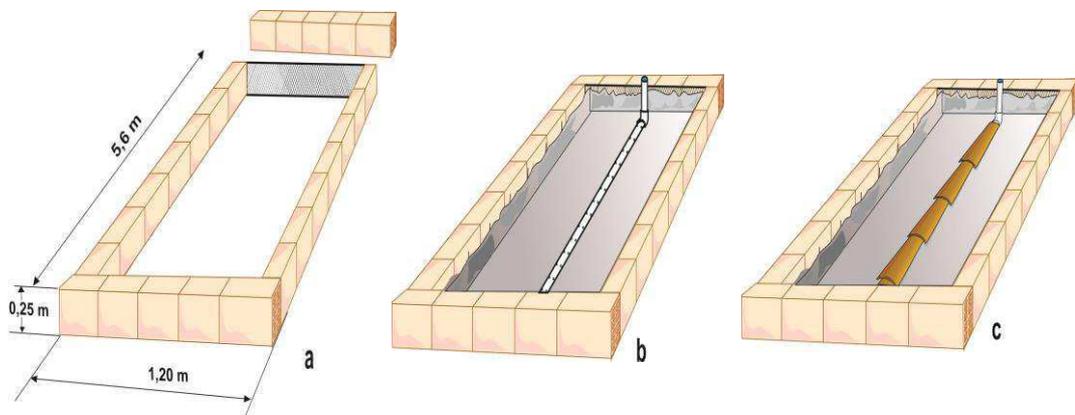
Desenho esquemático do canteiro econômico: tela lateral (a); lona e cano gotejador (b); telha de barro (c).
